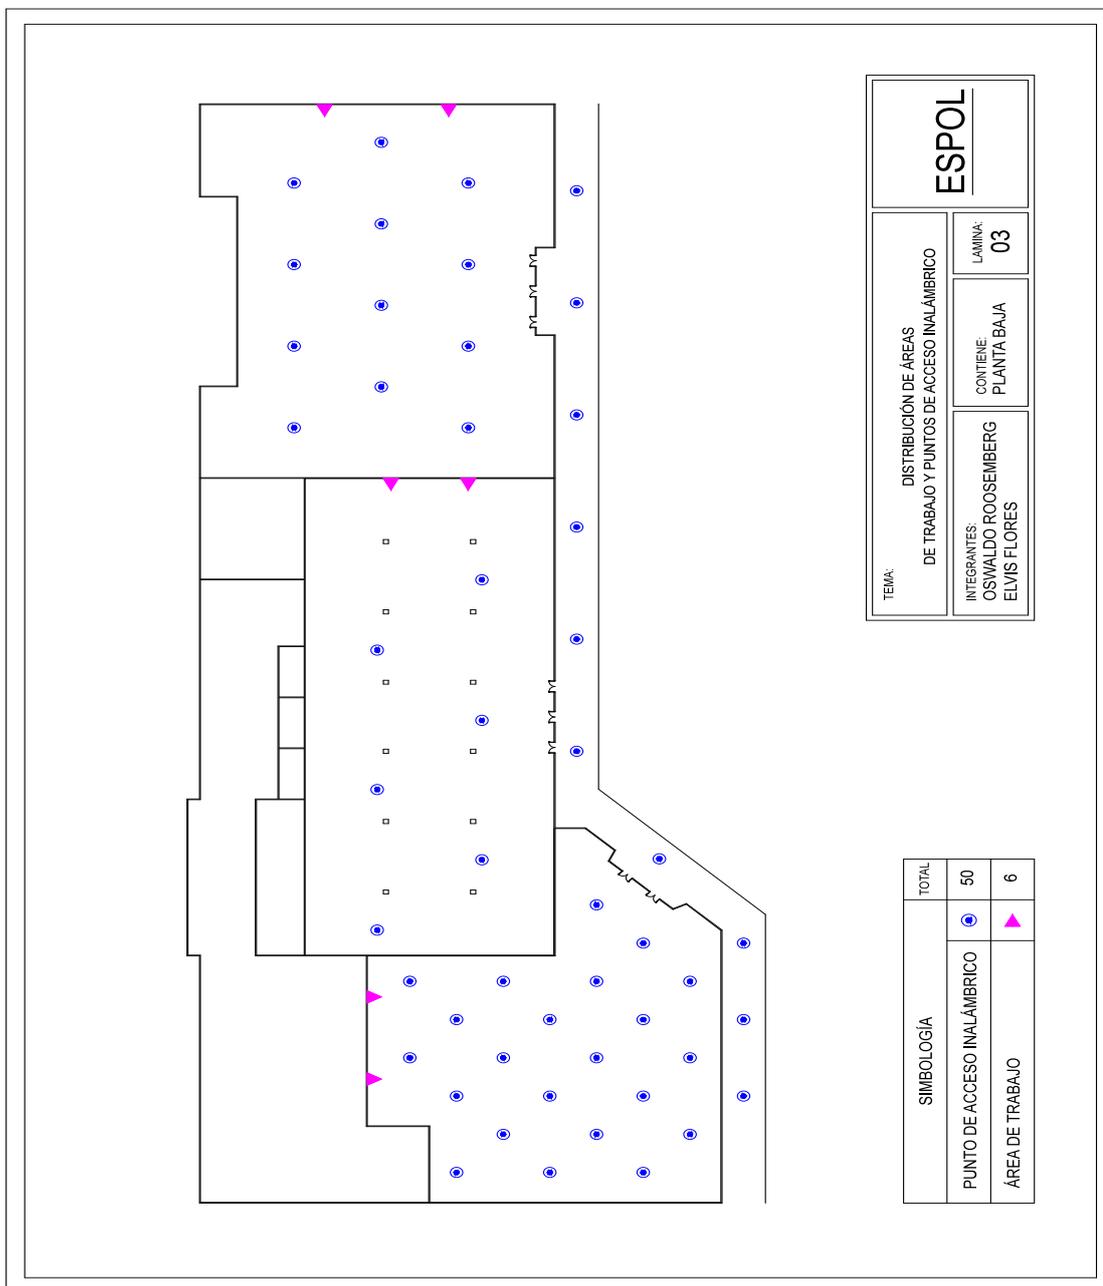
Plano de Distribución Áreas de Trabajo y Puntos de Acceso Inalámbrico – Planta Baja.
